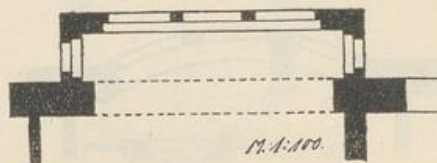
Pfeilervorlagen unzureichend wegen Möblierung und Deckenkonstruktion.
